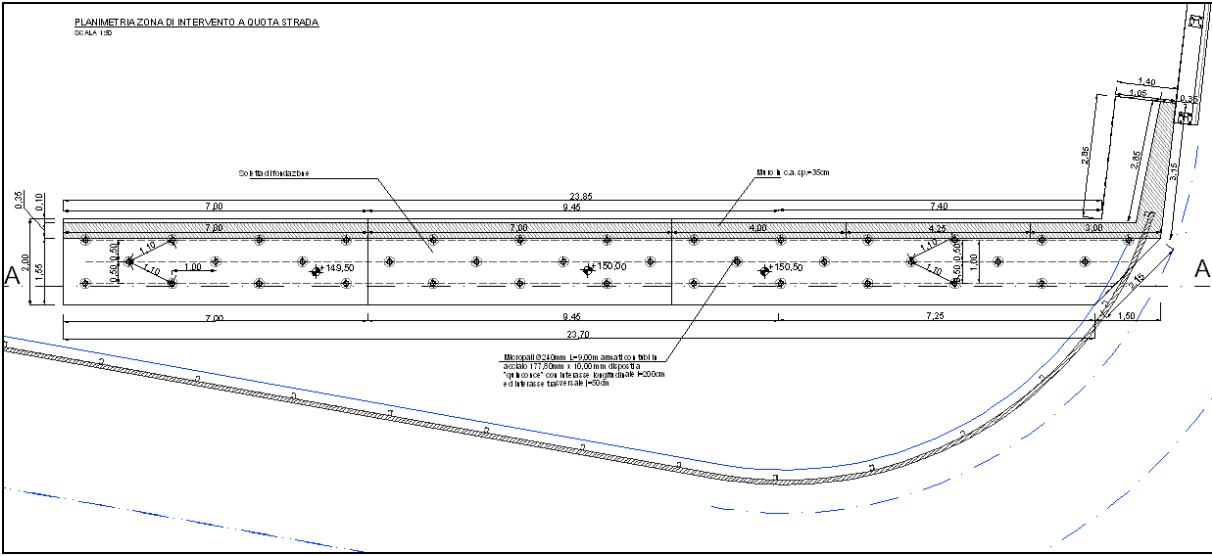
Planimetria di intervento con indicazione del muro di contenimento e delle fondazioni su micropali
